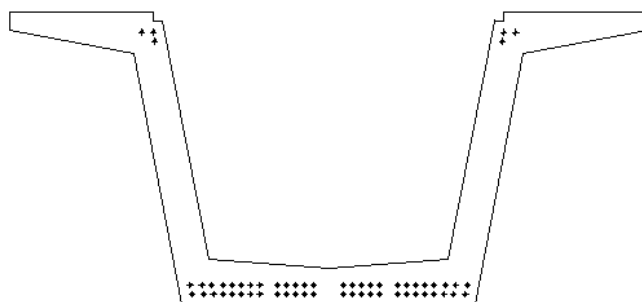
Disposizione armatura di precompressione nella sezione di campata
